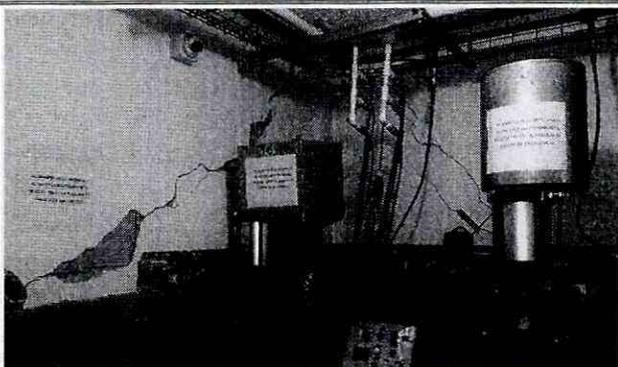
Grietas tendencia diagonal muro perimetral primer nivel de la vivienda – Enero de 2017
